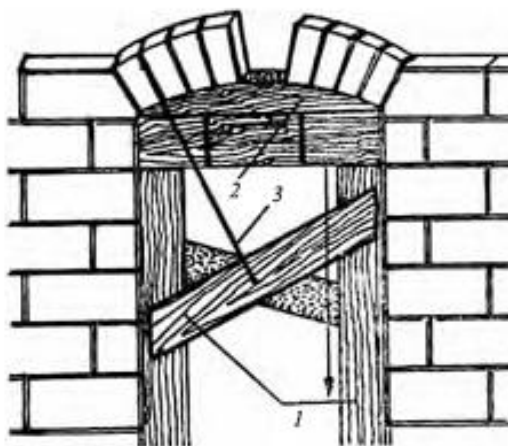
Опалубка с кружалом для кладки арочной перемычки: 1 — элементы опалубки; 2 — кружало; 3 — шнур для контроля радиуса арки.
